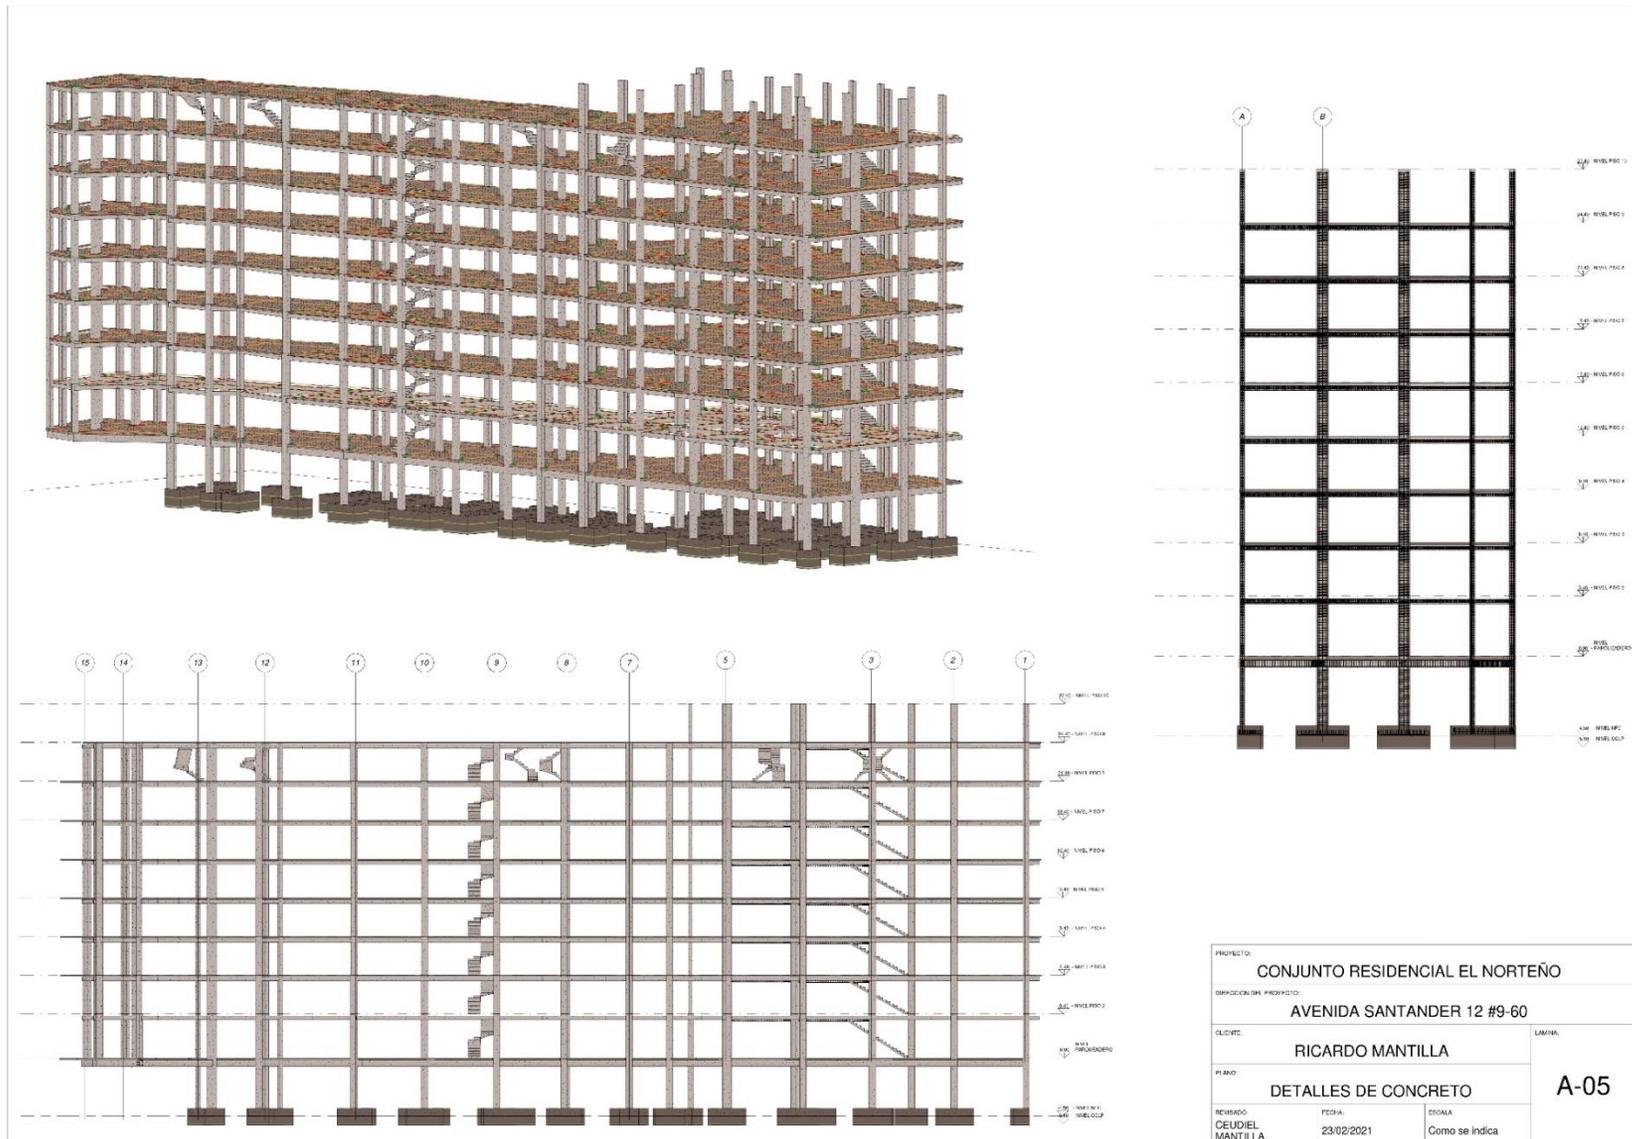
Detalles de concreto conjunto residencial el norteño, plano A105. Diseño de: REVIT 2021
